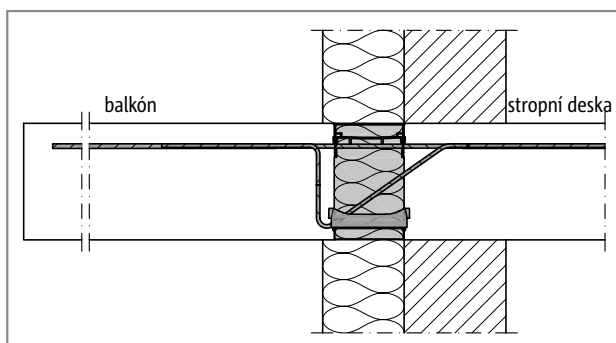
Schöck Isokorb® typ KXT: Balkón na zalomené fasádě (otevřený ze dvou stran)
